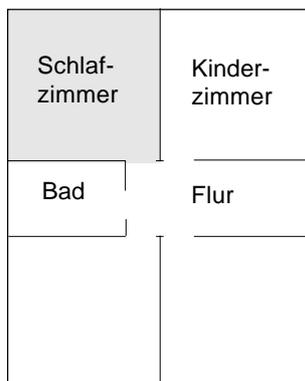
1: OG-Grundriß mit Schlafzimmer
